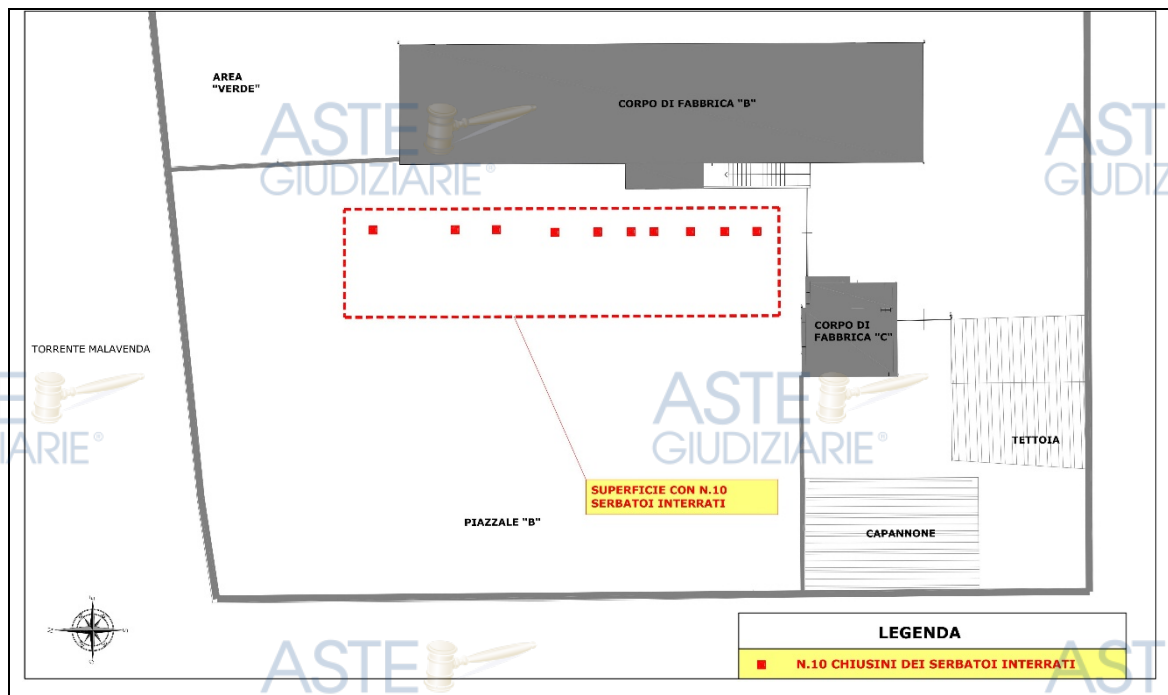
Stralcio planimetrico dell'immobile con indicazione zona vasche/serbatoi interrati
